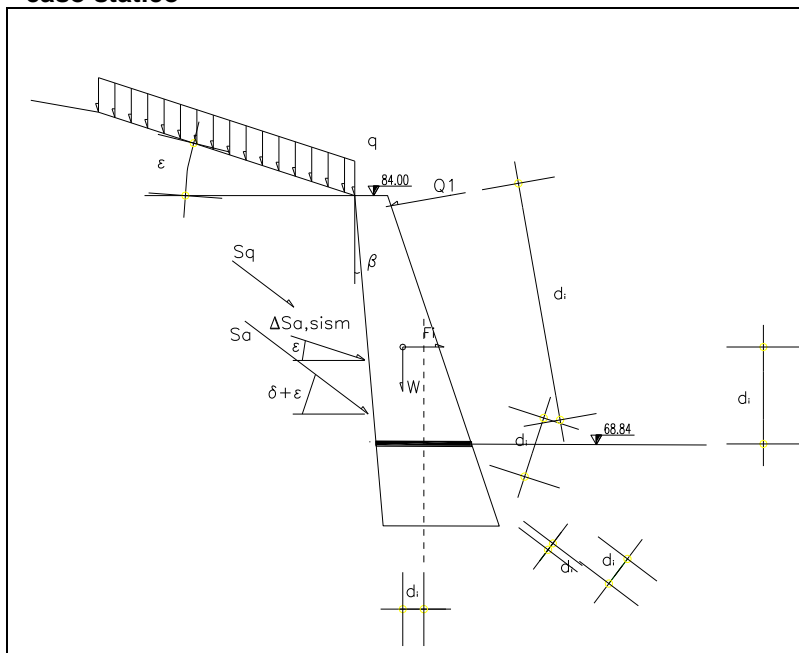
Schema di calcolo con indicazione delle forze agenti e dei rispettivi bracci rispetto alla sezione di verifica – caso sismico
